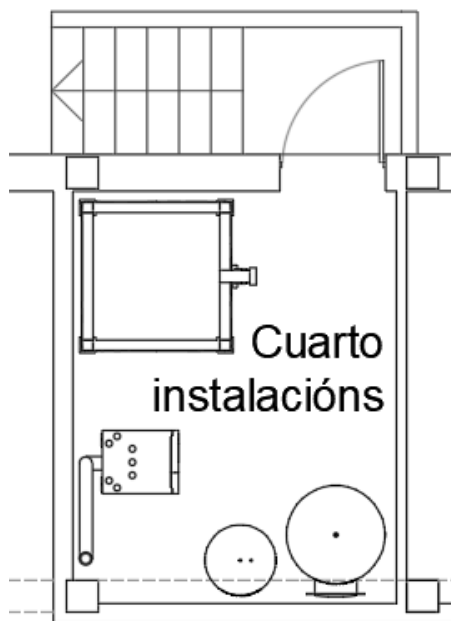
Distribución interior do cuarto de instalacións do edificio reformado. Elaboración propia.
